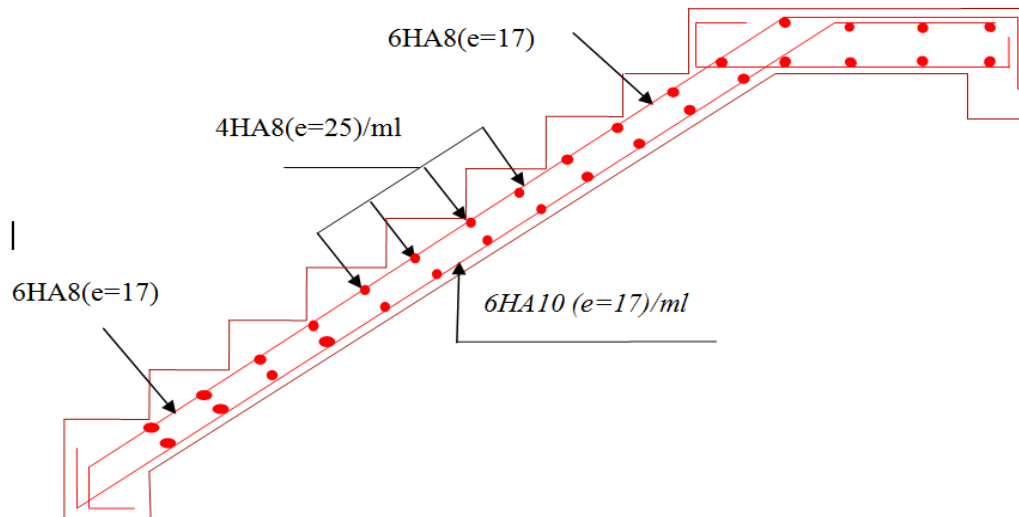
Schéma de ferrailage de l'escalier RDC 2^{ème} volée
